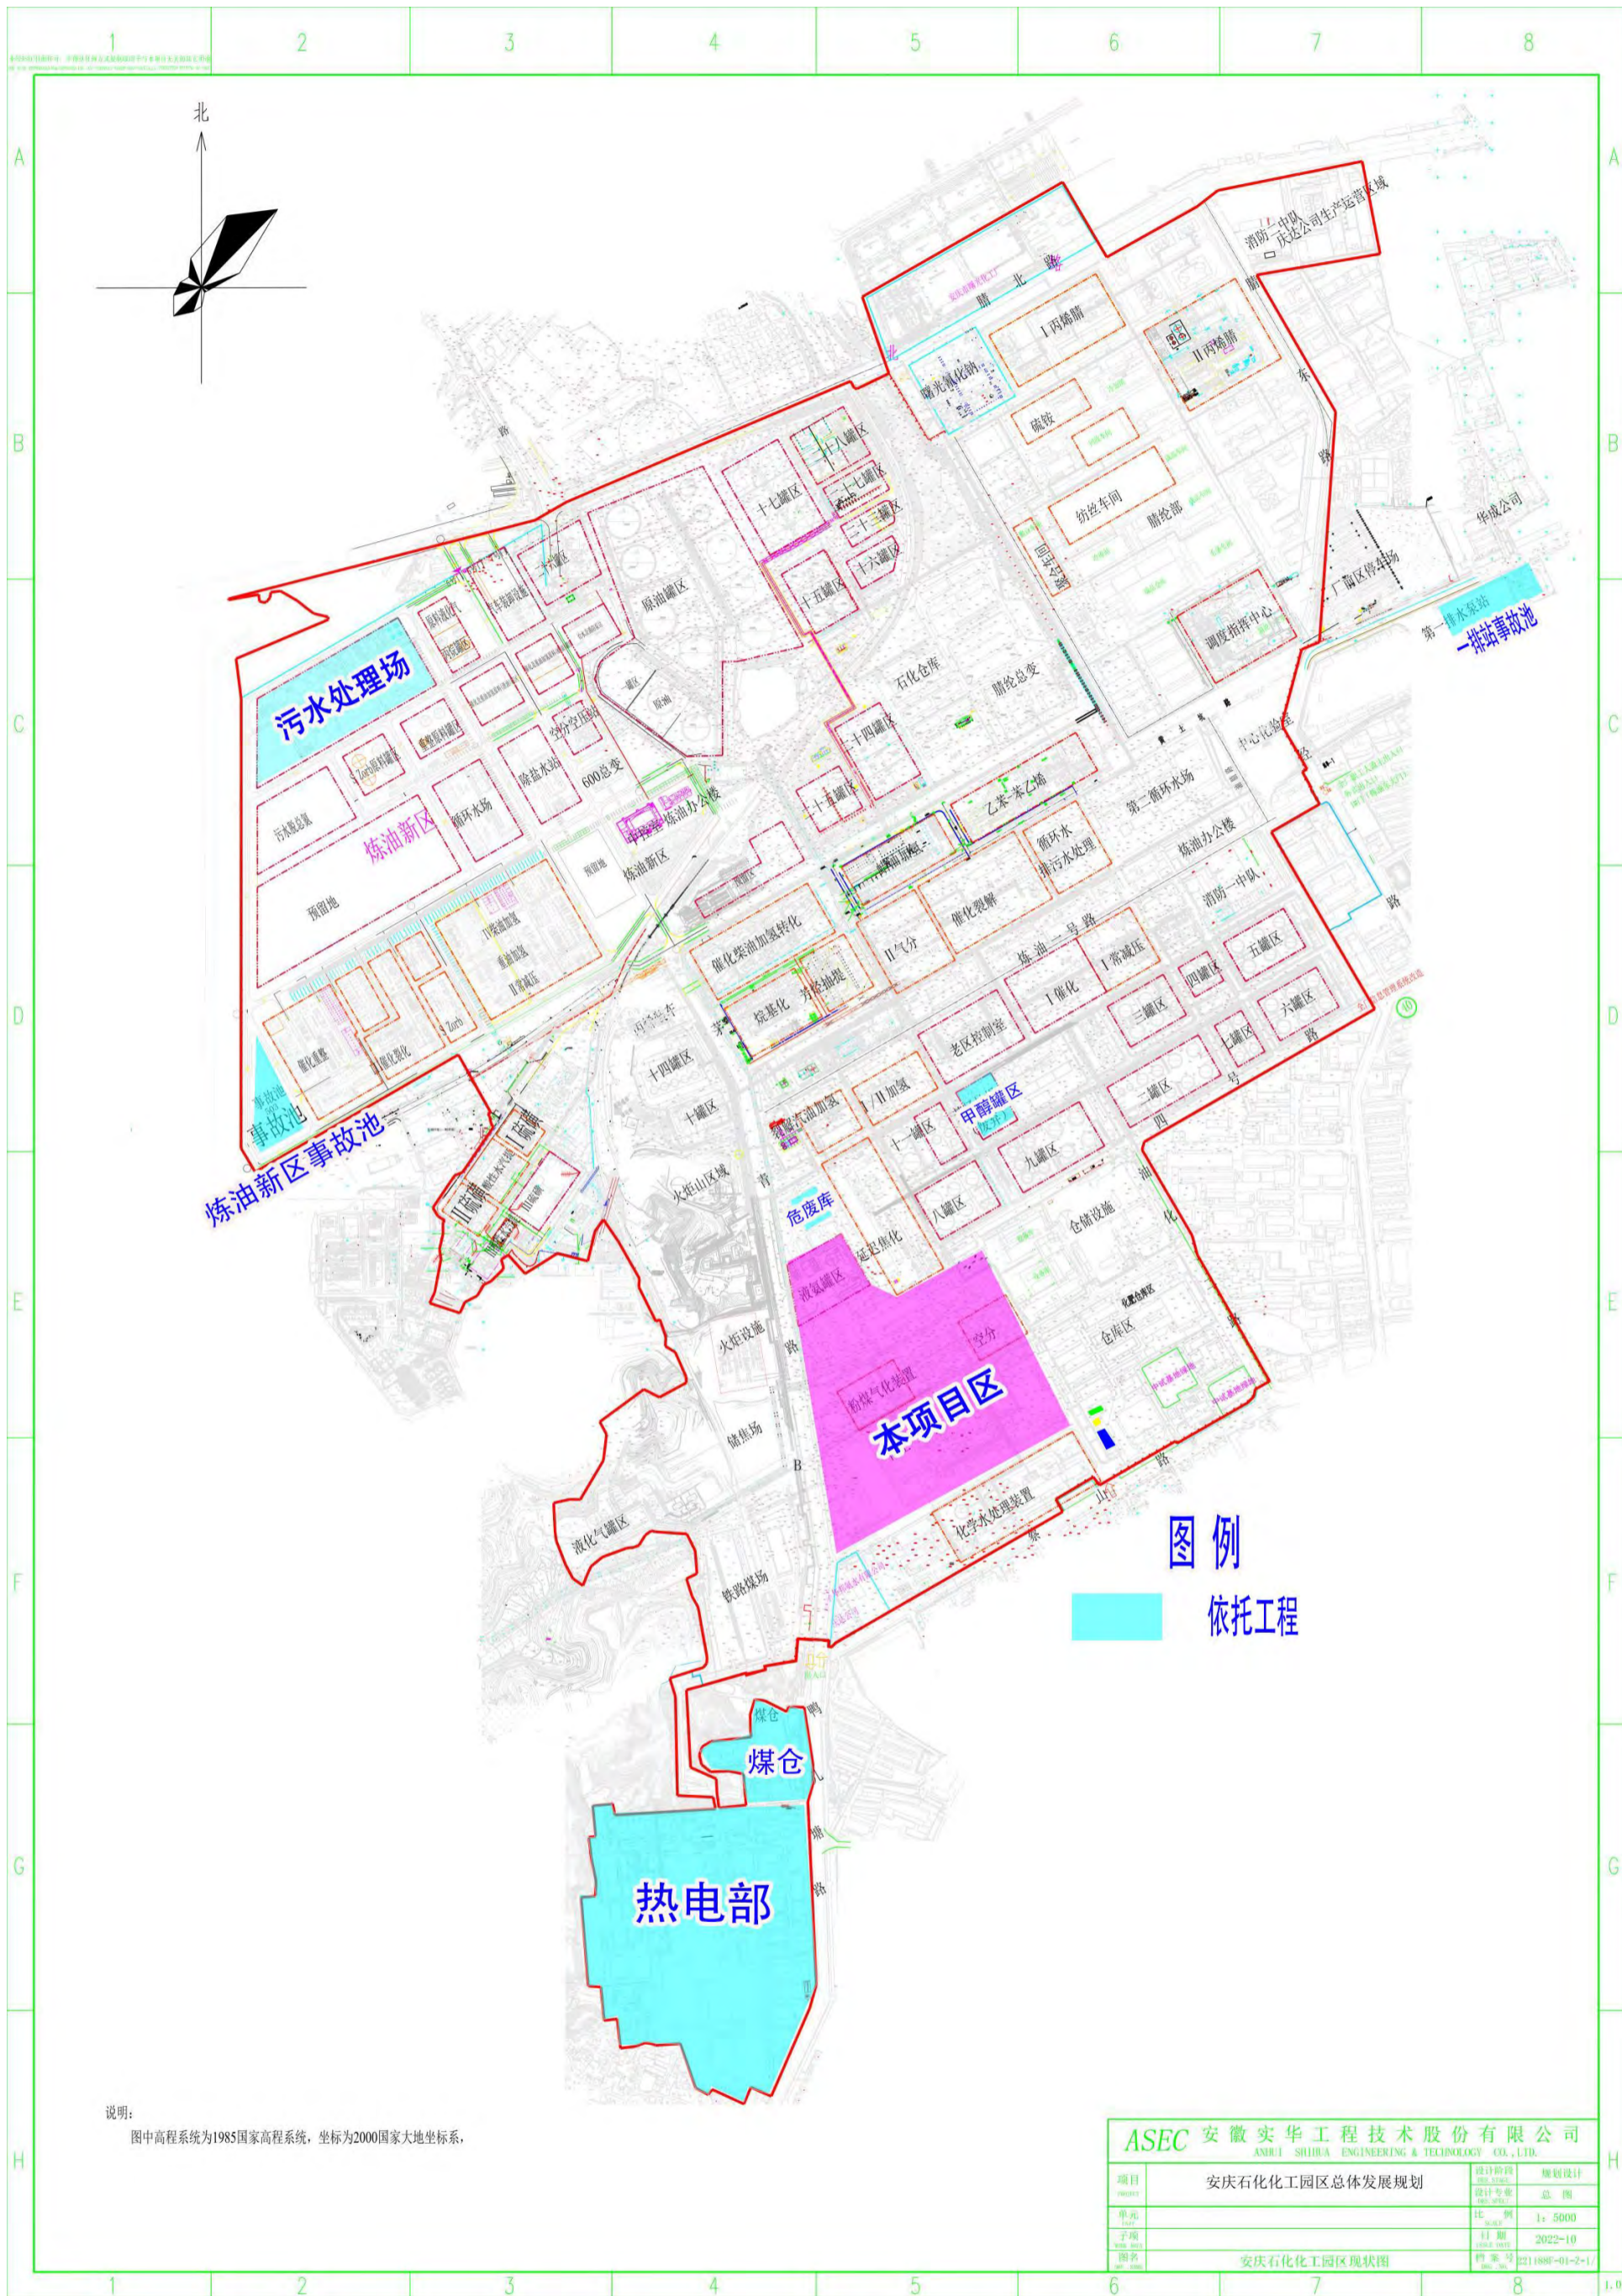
安庆石化厂区总平面布置图 (含本项目位置及依托工程分布)
